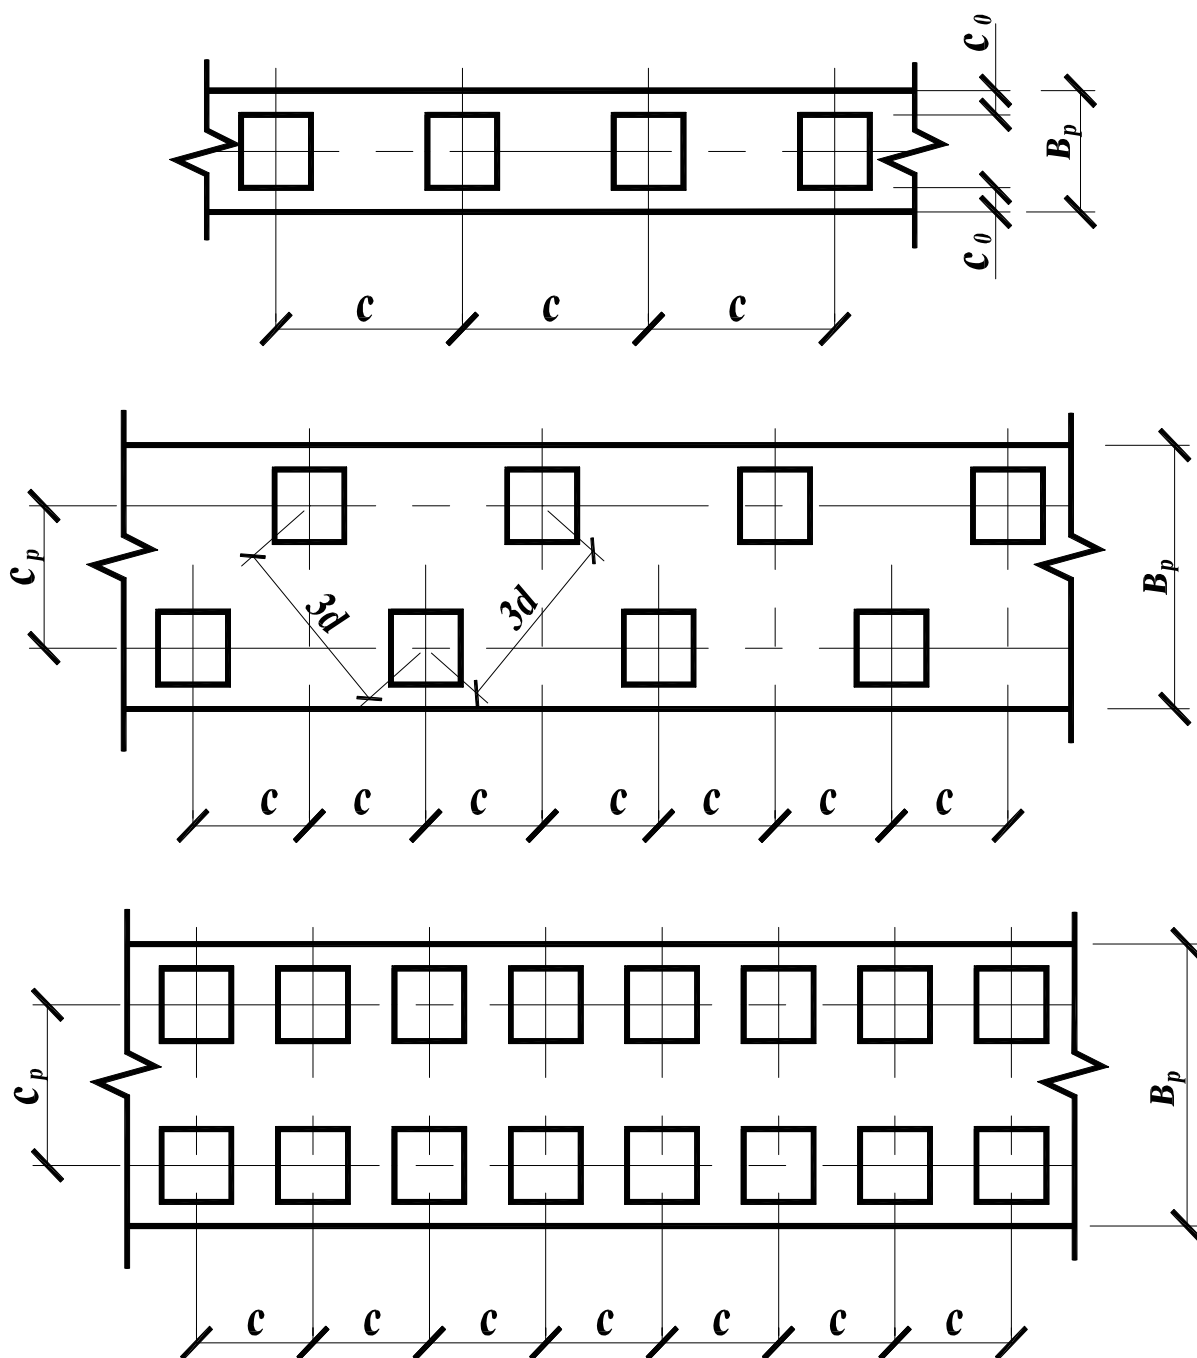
Расположение свай в плане в ленточном свайном фундаменте
